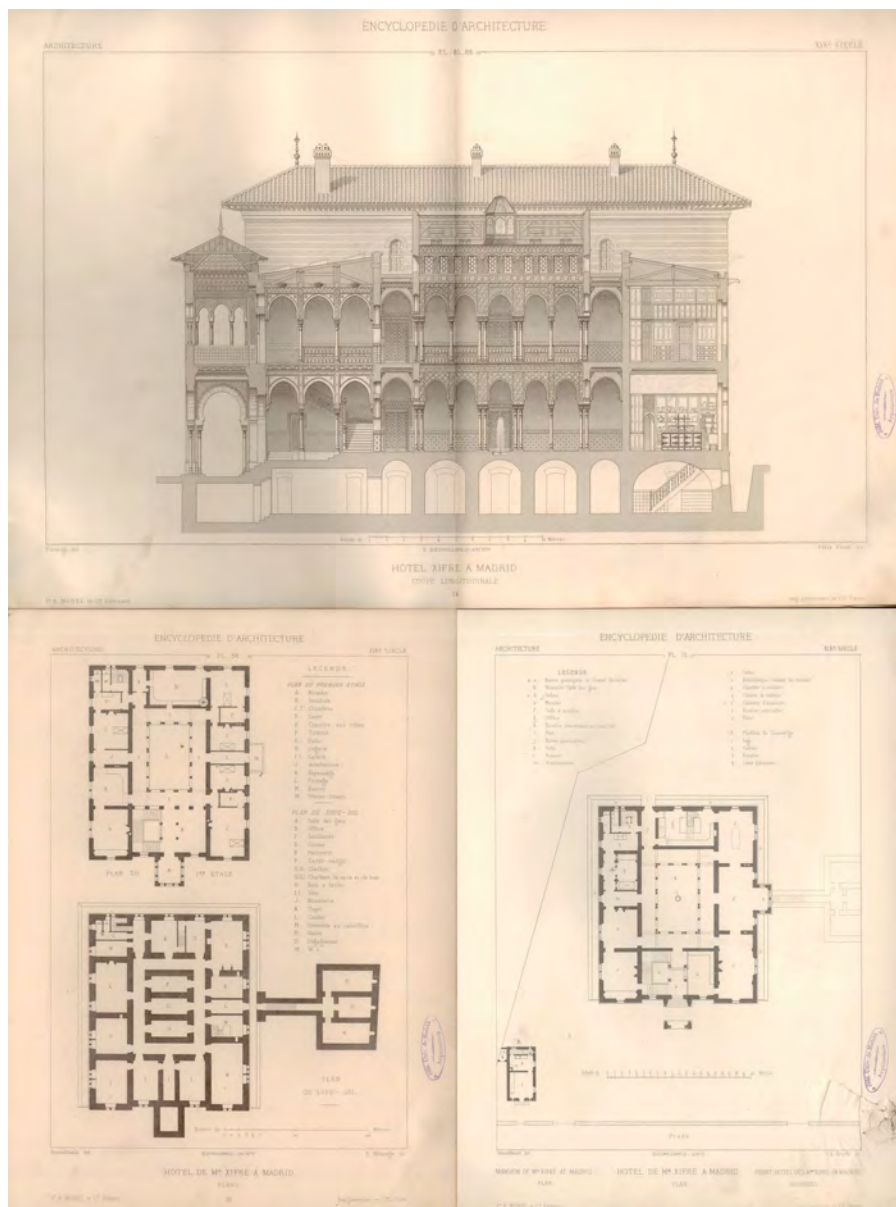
Sección transversal y plantas publicadas por Enciclopedie d'Architecture.
